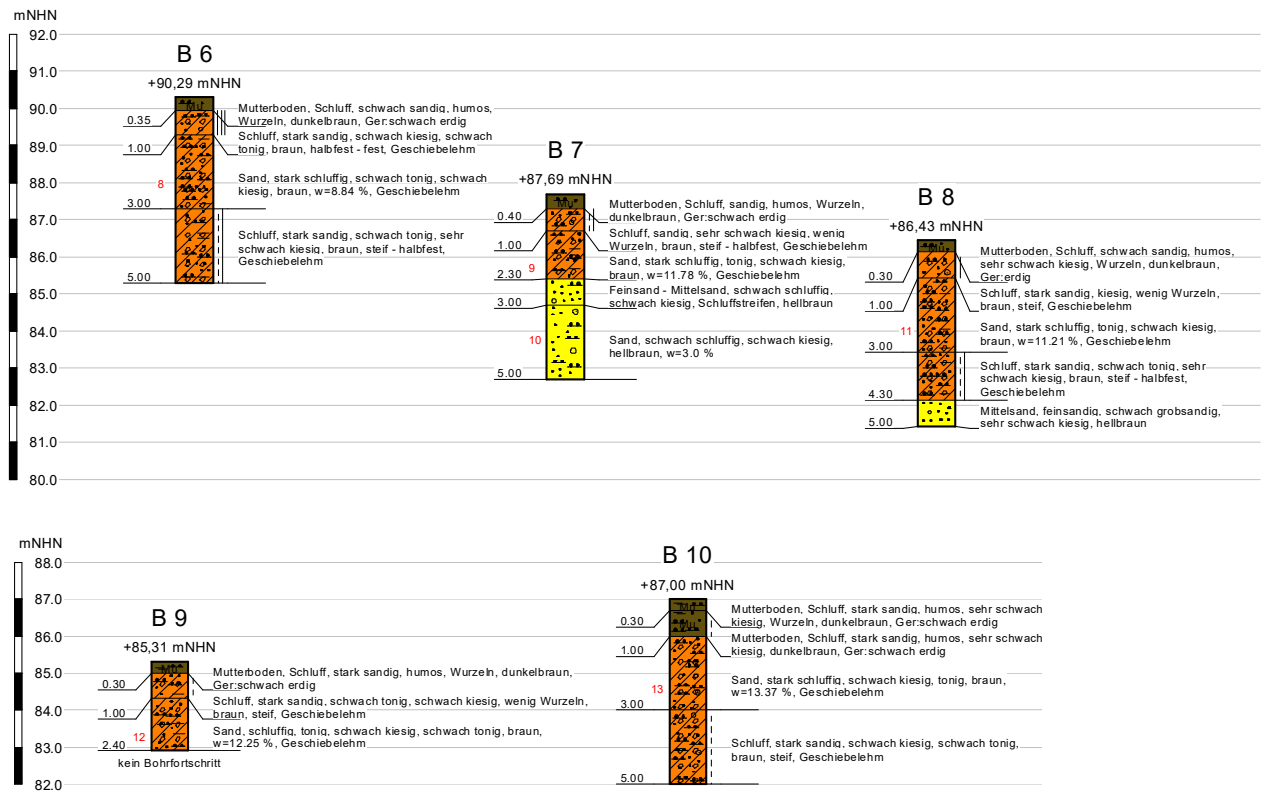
Bohrprofile und Lageplan der Erkundungsstandorte
